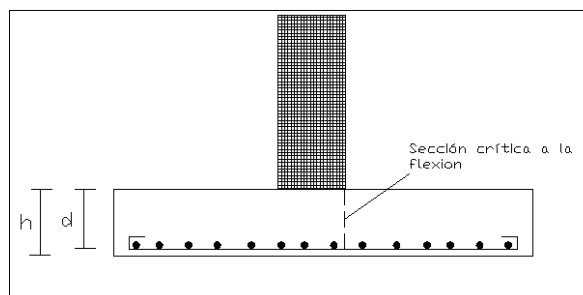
Sección Crítica a la flexión en cimentaciones de Hormigón Armado
